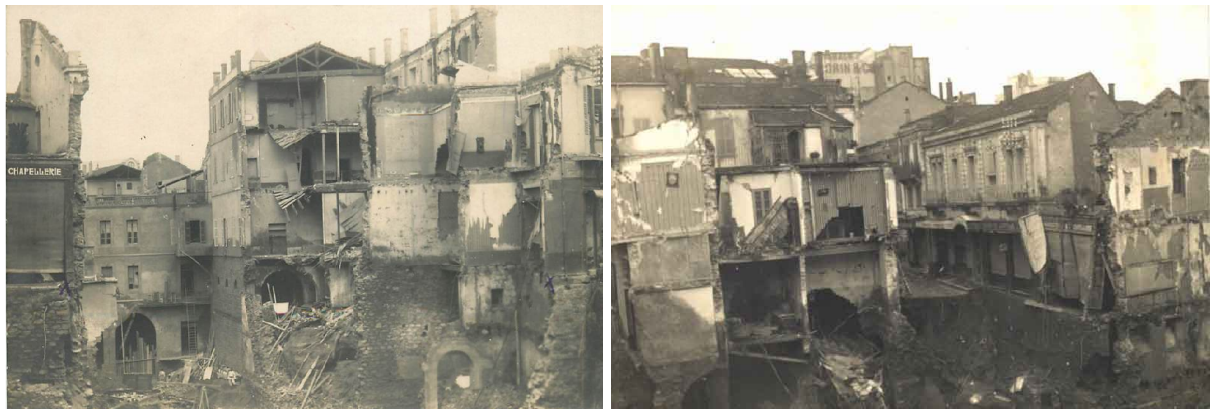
Les dégâts sur la place de Gambetta (Source: photos d'archives).
